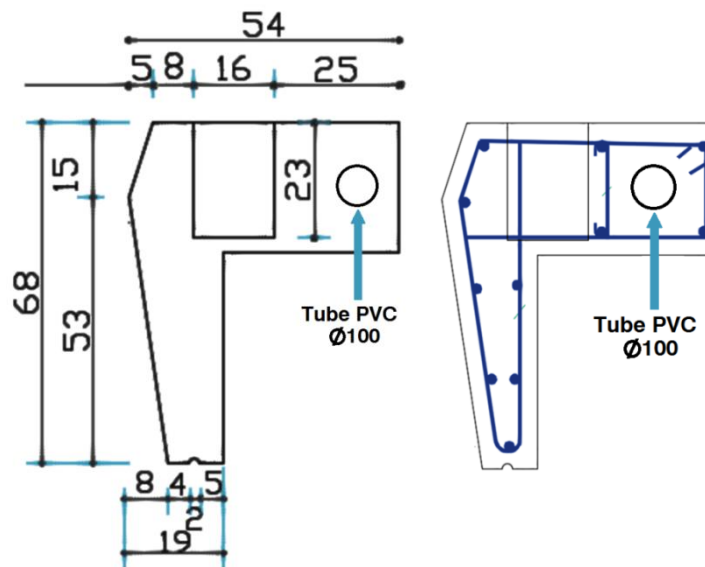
Coupe transversale A-A (Dimensions et ferrailage de la corniche).
